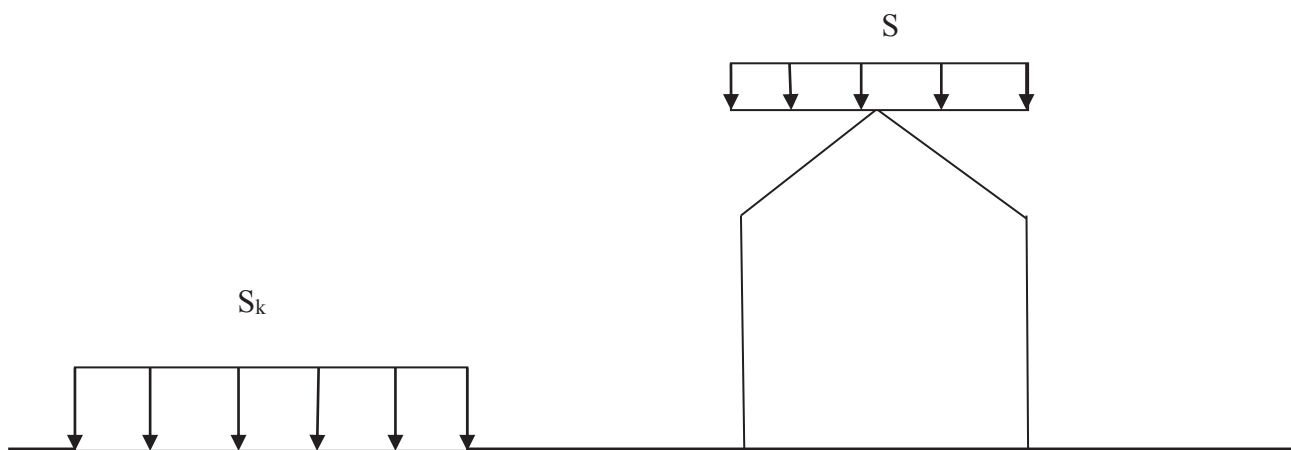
charge de neige sur les toitures ou autres surfaces
